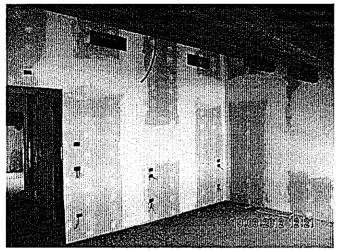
Stanza 2.5: Vista parete interna con porta ingresso
